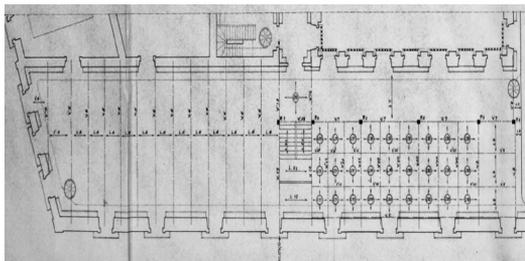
Planta estrutural da ala poente do piso 2 do edifício (excerto retirado do projeto original) [10].
